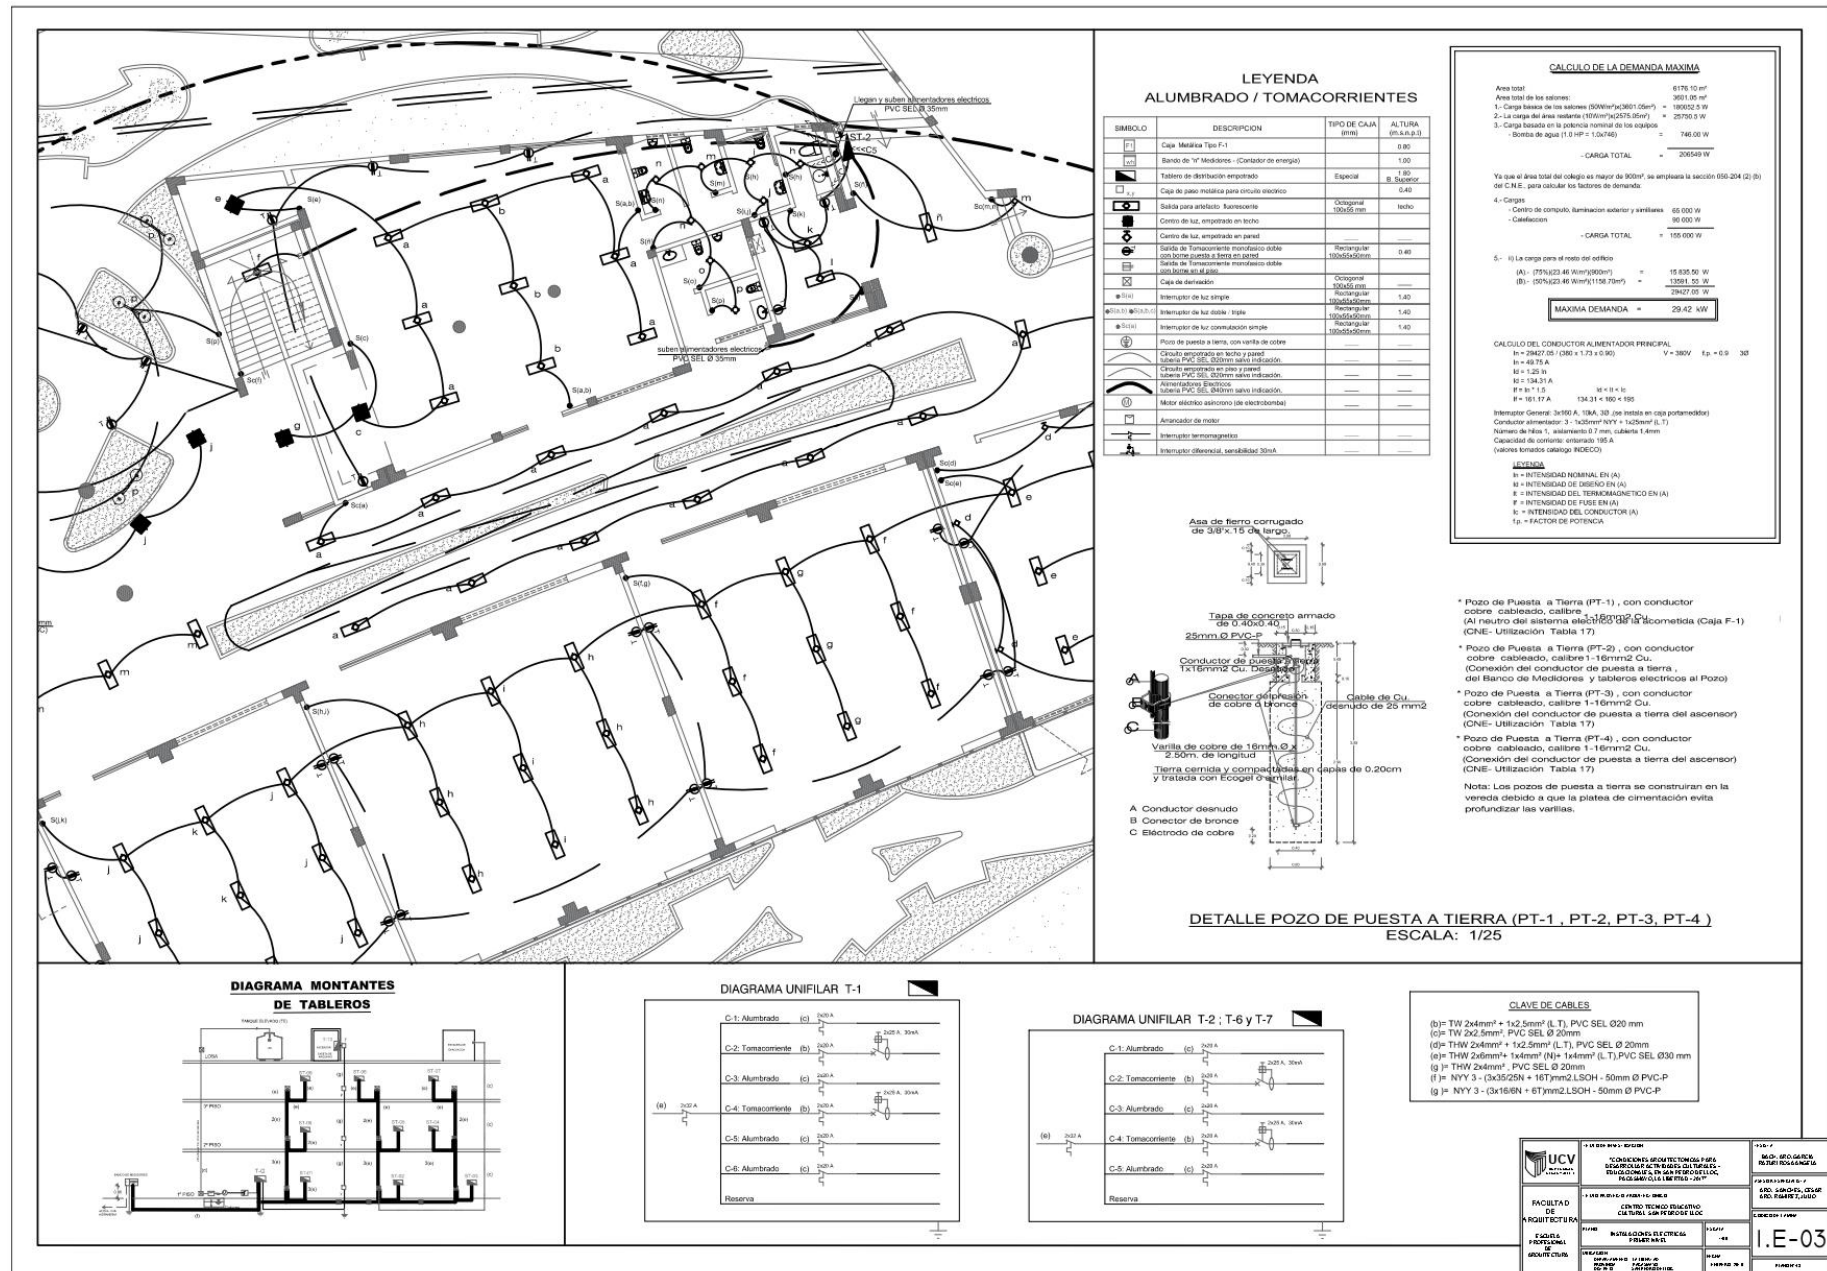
Plano de Instalaciones Eléctricas 1er Nivel - Plano N° 48 - Lámina N°: I.E. - 03
